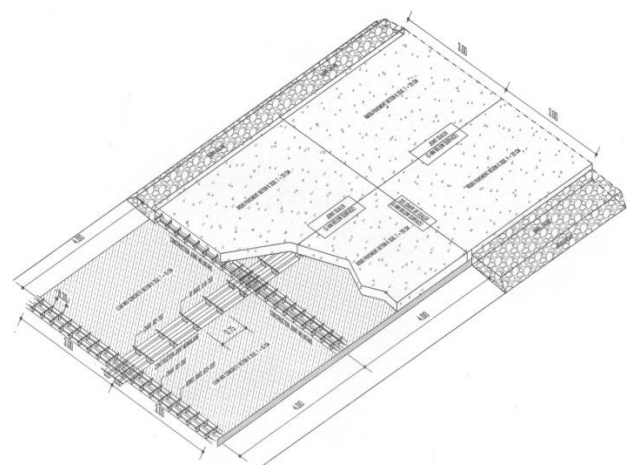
Detail Pembesian Rigid Pavement Per Segmen
